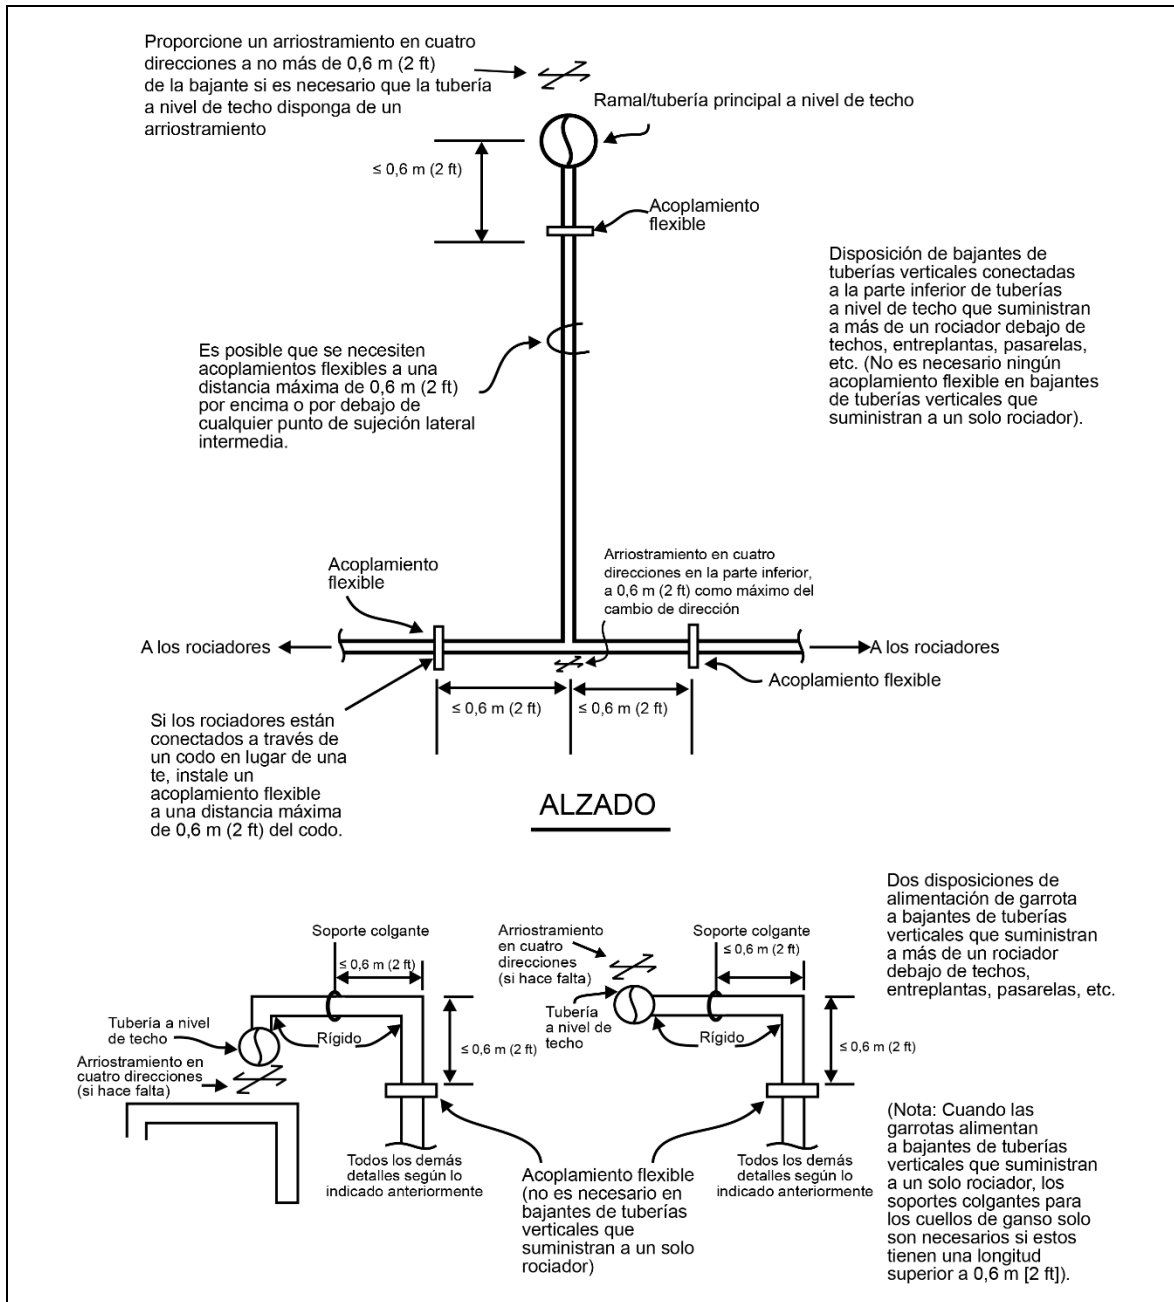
Disposición de bajantes de tubería que suministran a rociadores bajo techos, entreplantas, pasarelas, etc.
